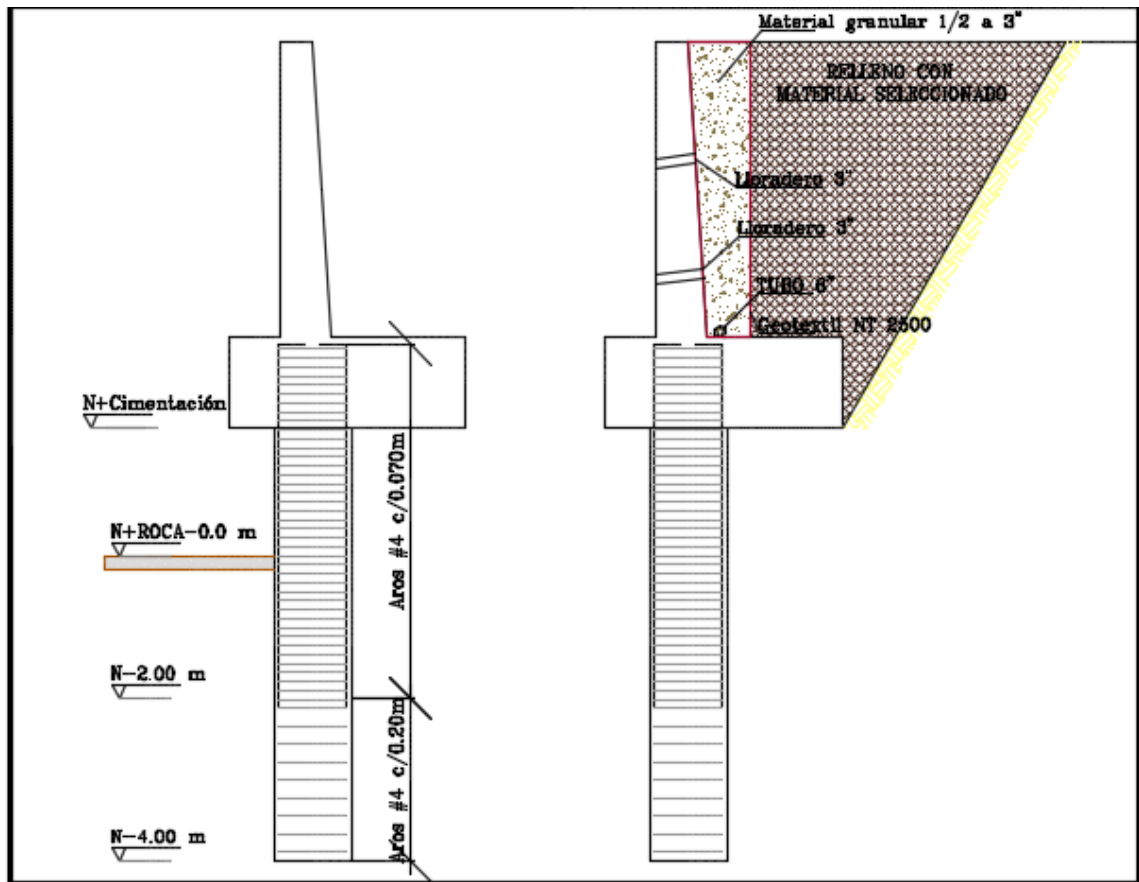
Vista genera de cimentación de muro sobre pilotes.
